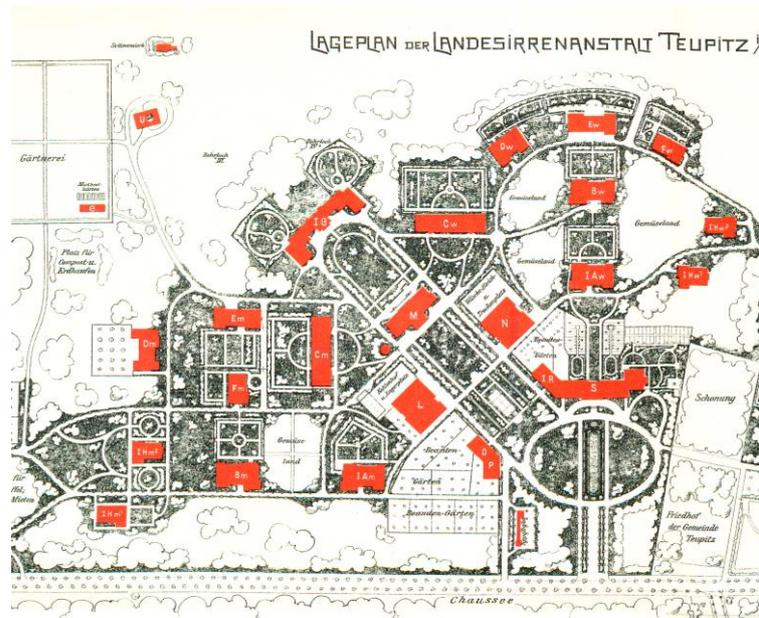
Ausschnitt Hauptanstalt Lageplan 1908
